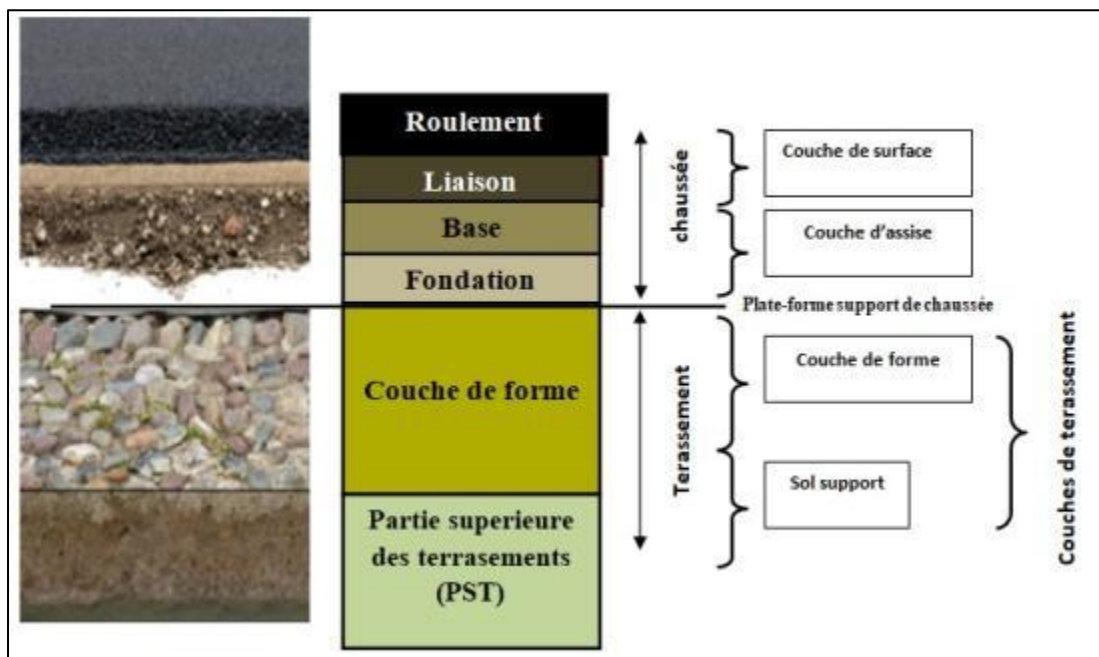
Composition structurelle d'une chaussée bitumineuse — couches et rôles
